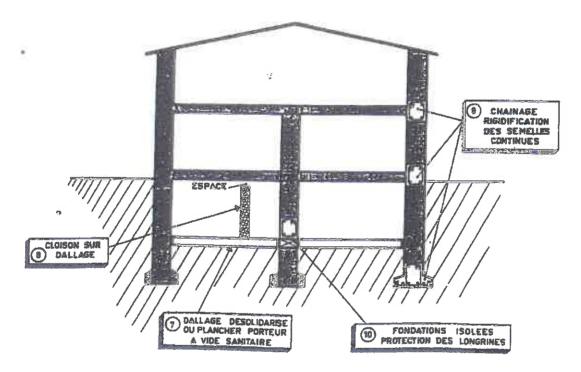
Mesures destinées à adapter la structure à un gonflement du sol de fondation
